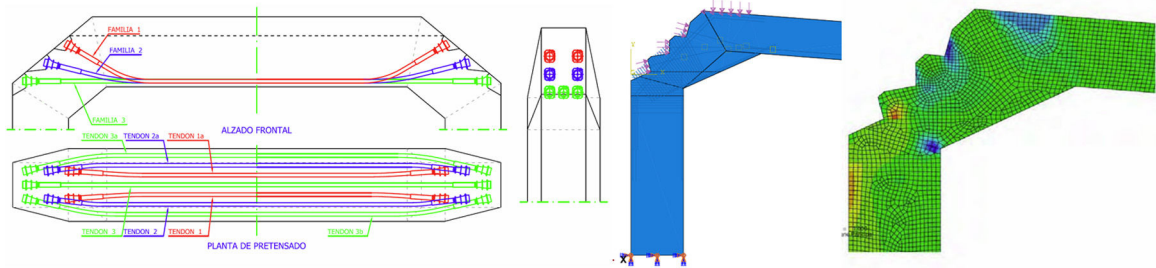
Modelo de elementos finitos de dintel de pilas pórtico, detalle de región D.
